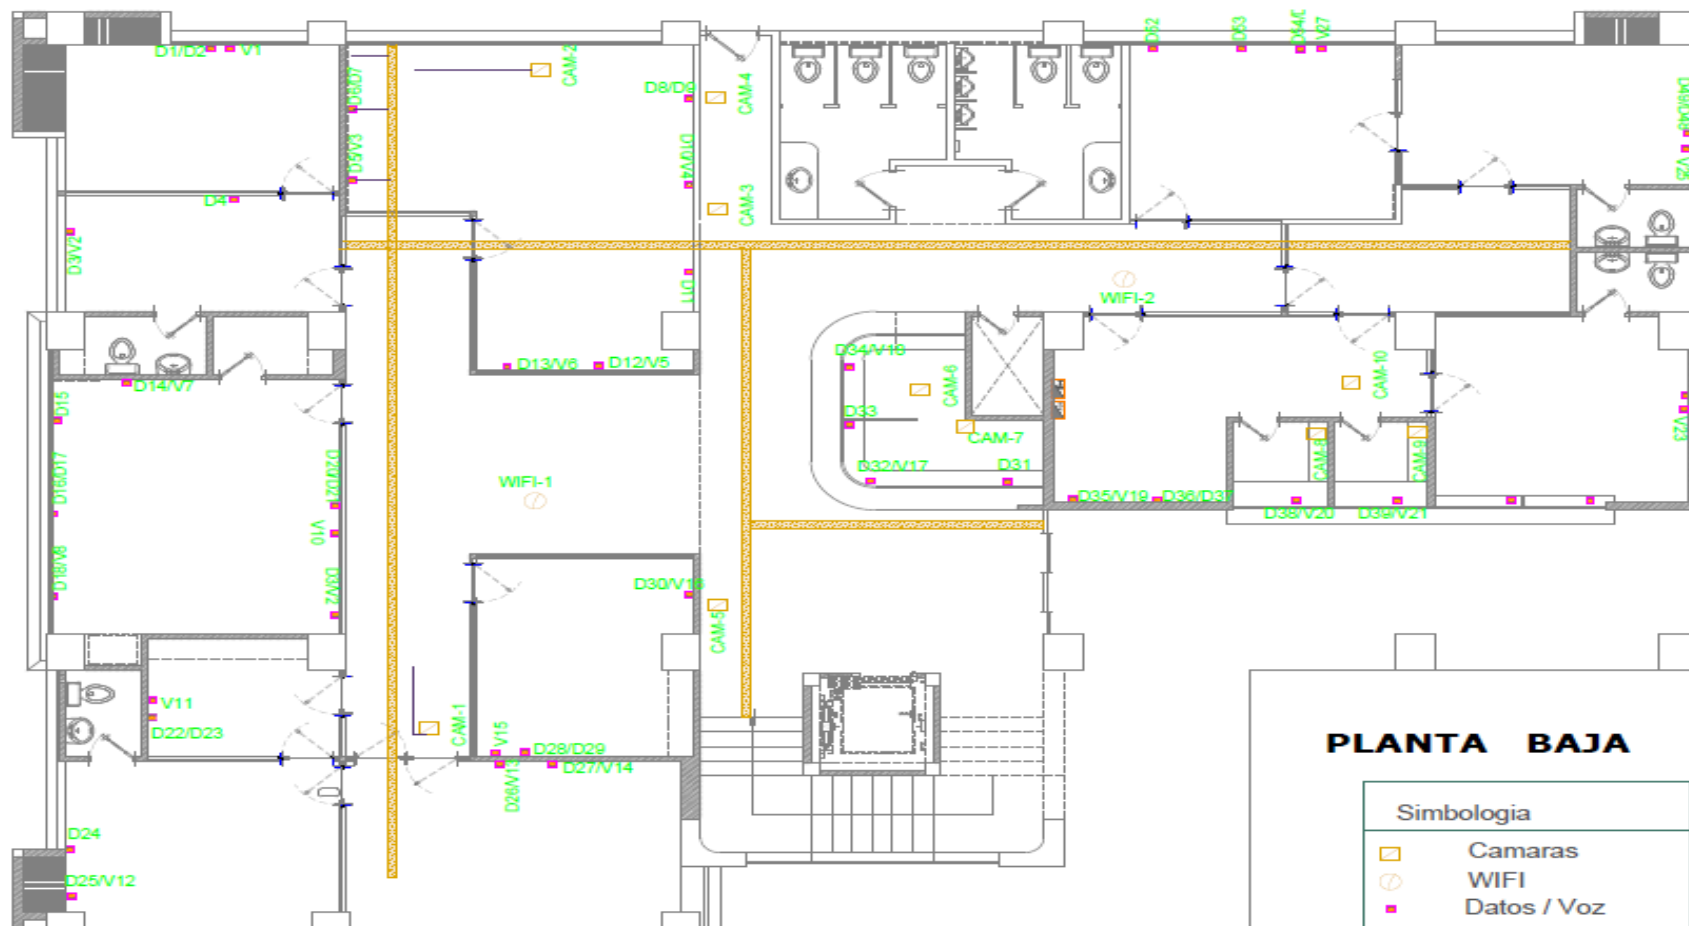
Plano correspondiente Planta Baja Elaborado por: (GADPLR [Imagen], 2014), Investigadoras
